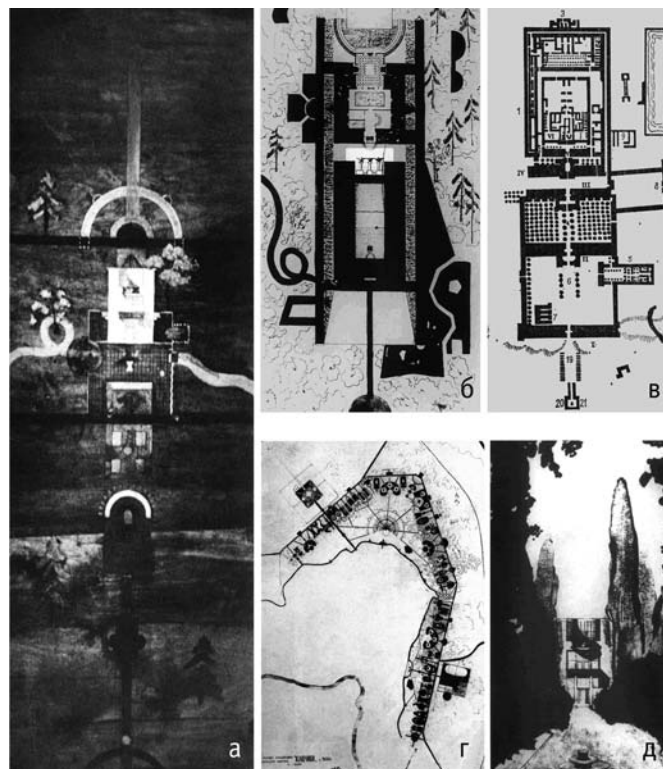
Проект посёлка в Нижнем Тагиле. Изображение авторов исследования (кадр из анимации): а, б) варианты генеральных планов участков; в) план комплекса в Карнаке; г) генеральный план посёлка Ключики; д) фасад жилого дома в Ключиках. Рисунок Леонидова
